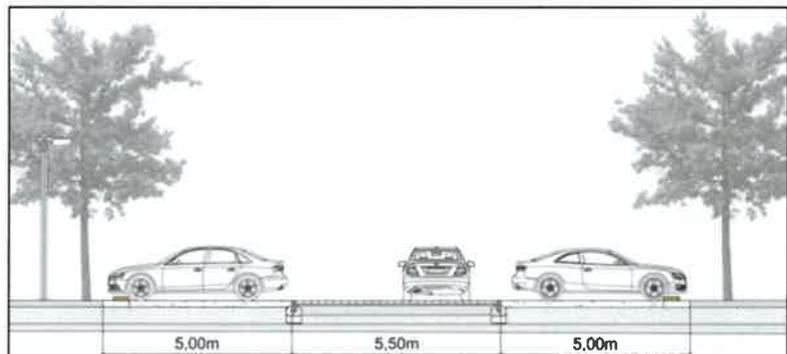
Private Erschließung 5,50 m Fahrbahn im Zweirichtungsverkehr zur Andienung von Senkrechtstellplätzen der Grundstücke Bretterbude und Shopgebäude Beach Motel sowie zur Anlieferung Grundstück Beach Motel
